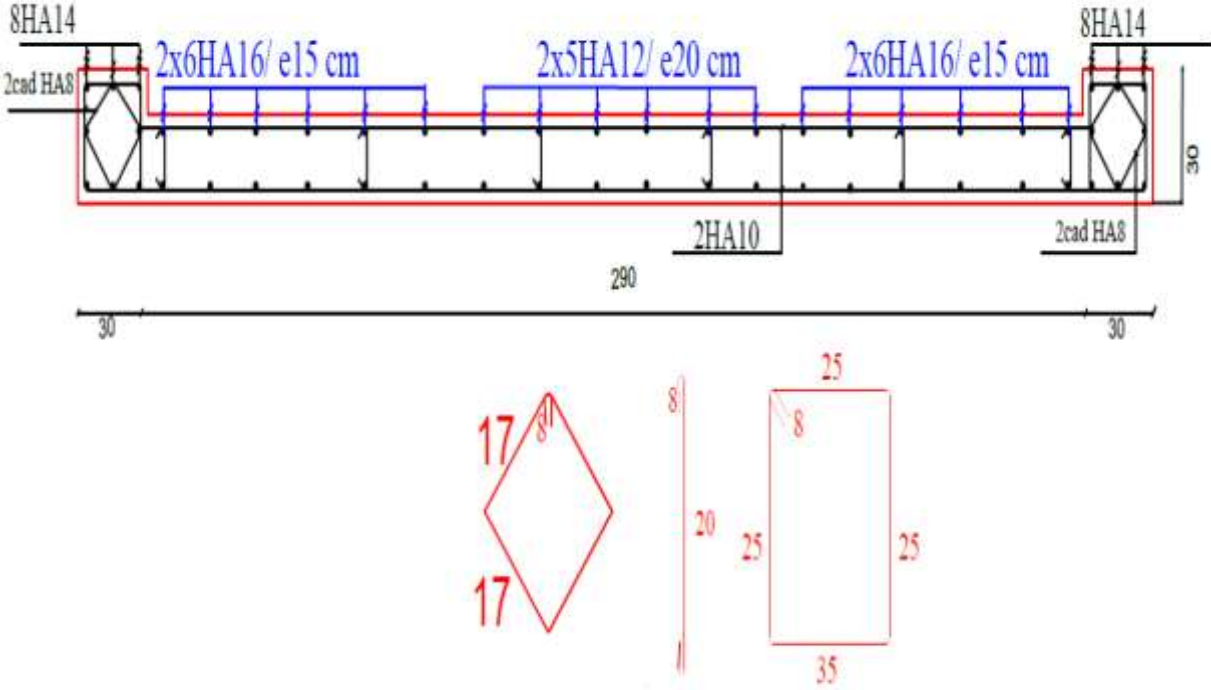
Coupe 1-1 de ferrailage d'un voile
